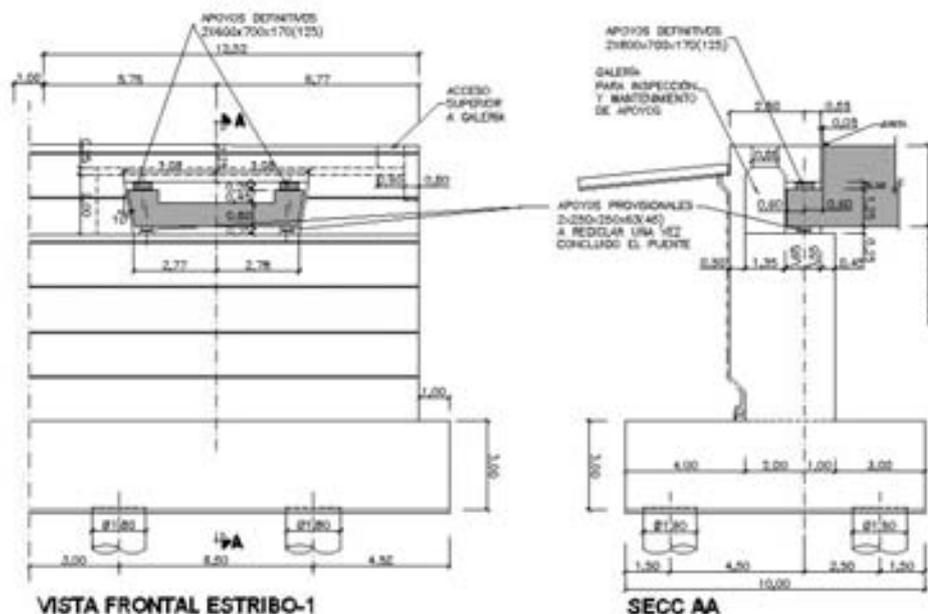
Vista del alzado y sección de los estribos con los detalles de los apoyos inversos.
